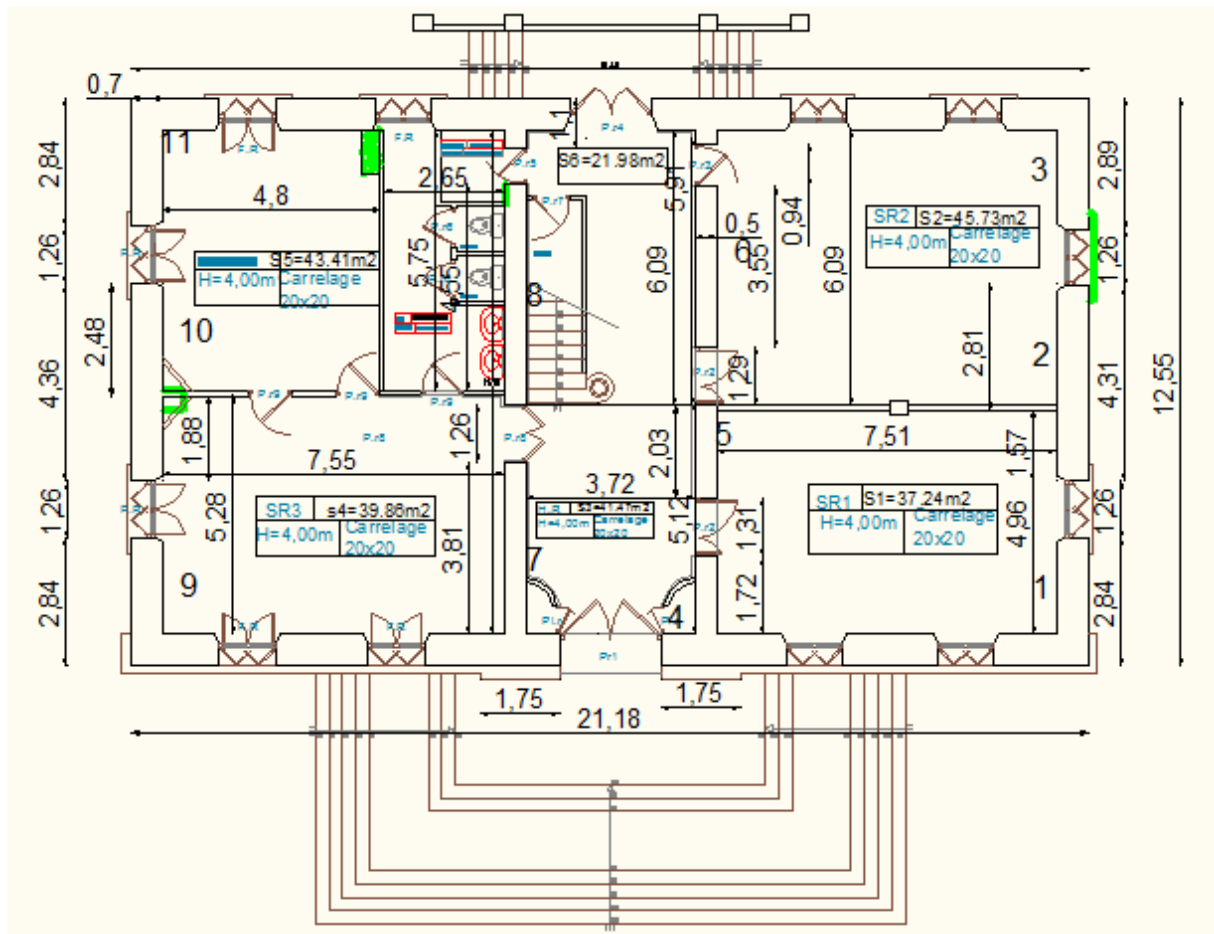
Exemple de construction en maçonnerie dans le centre ville de Tizi-Ouzou.
